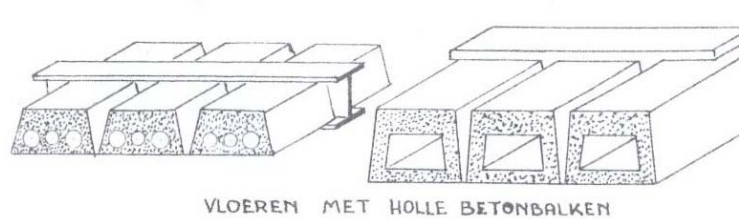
Vloeren opgebouwd met holle betonblokken [1]
